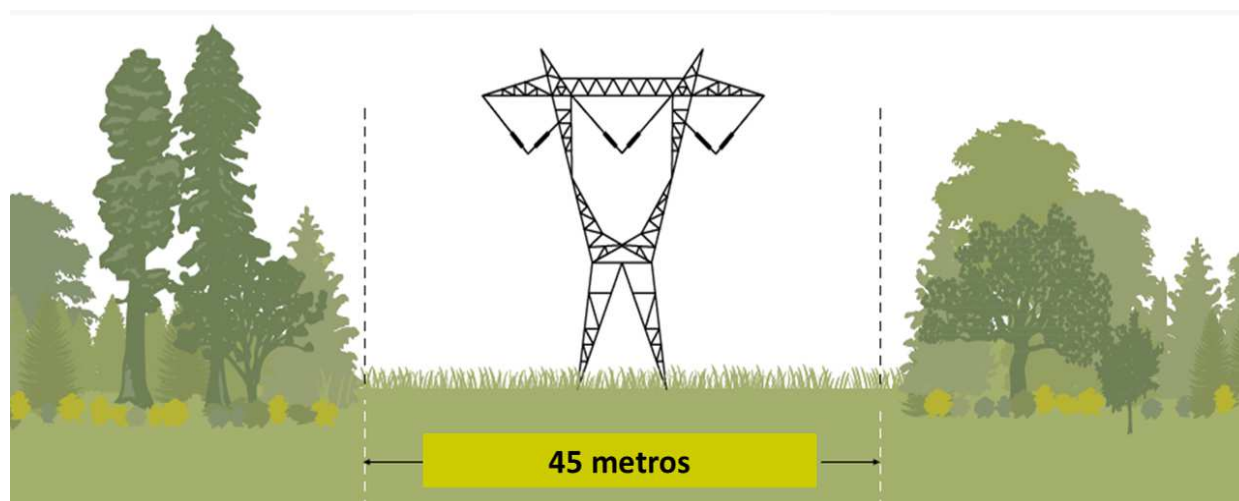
Faixa de servidão de linha de transporte de electricidade⁴
